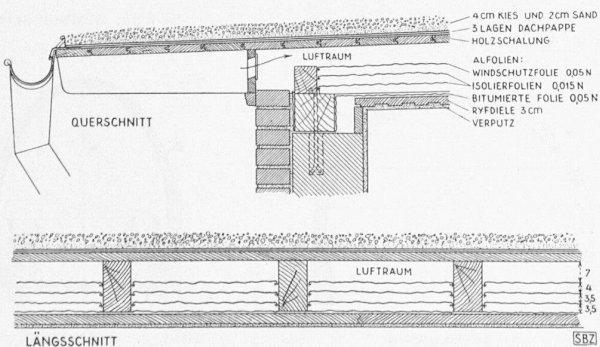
Dachausbildung mit Isolation, Masstab 1 : 25
